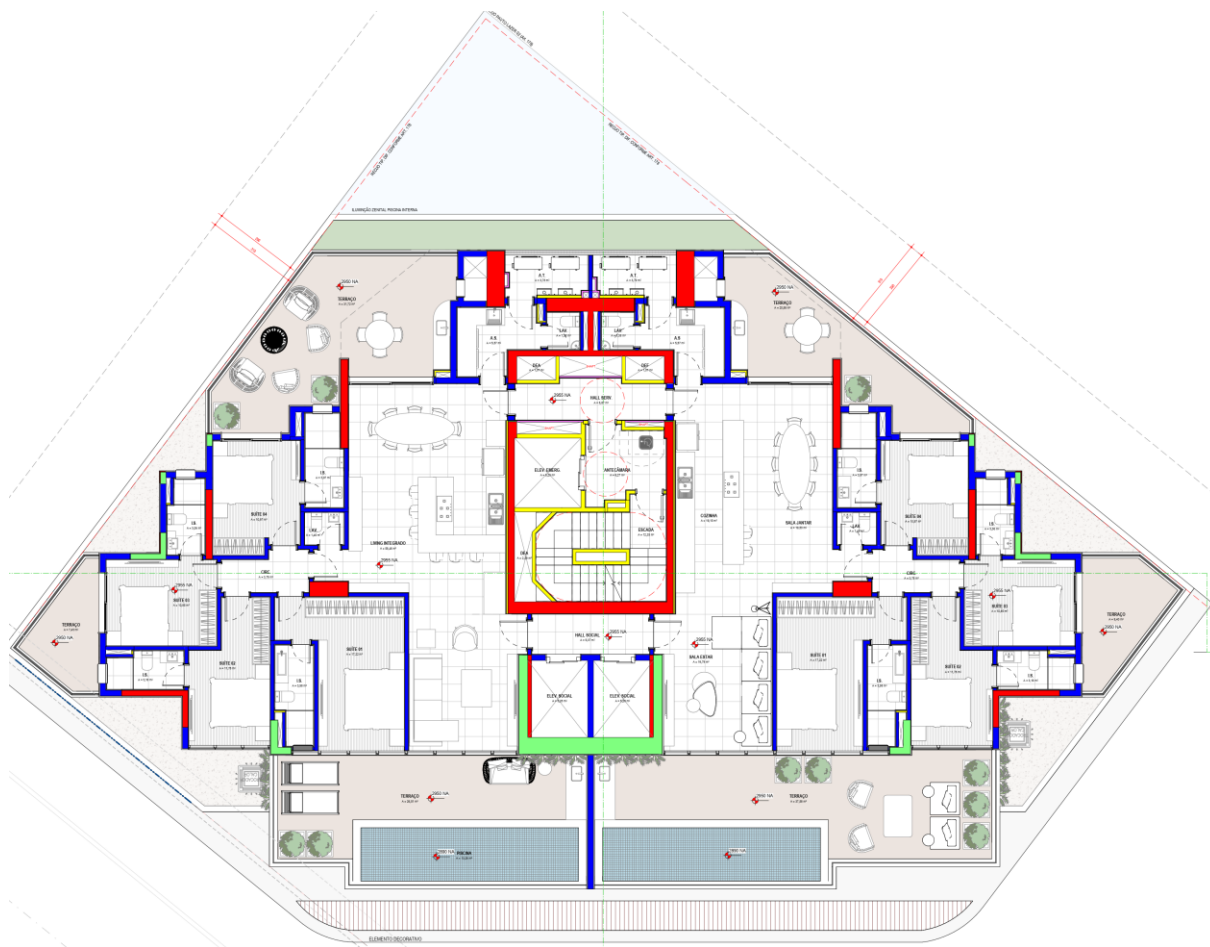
Pavimento 9º - Residencial 1º Tipo Diferenciado
